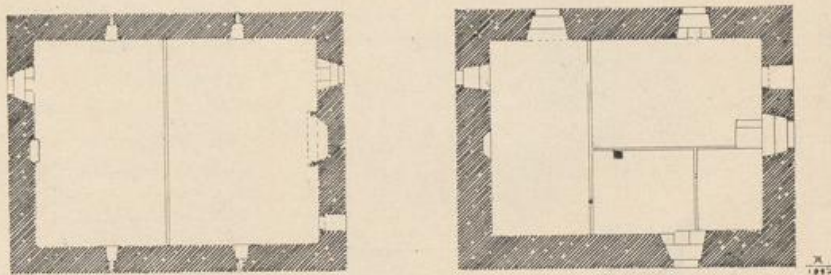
Haus Ober-Sülz. Grundrisse der Obergeschosse.
